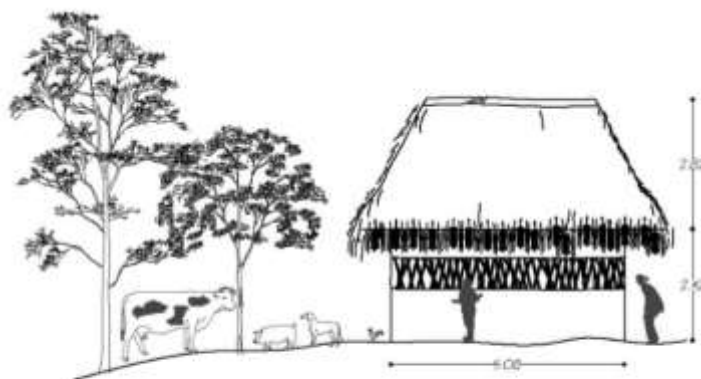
Fachada lateral. Vivienda Quitora Huepa
